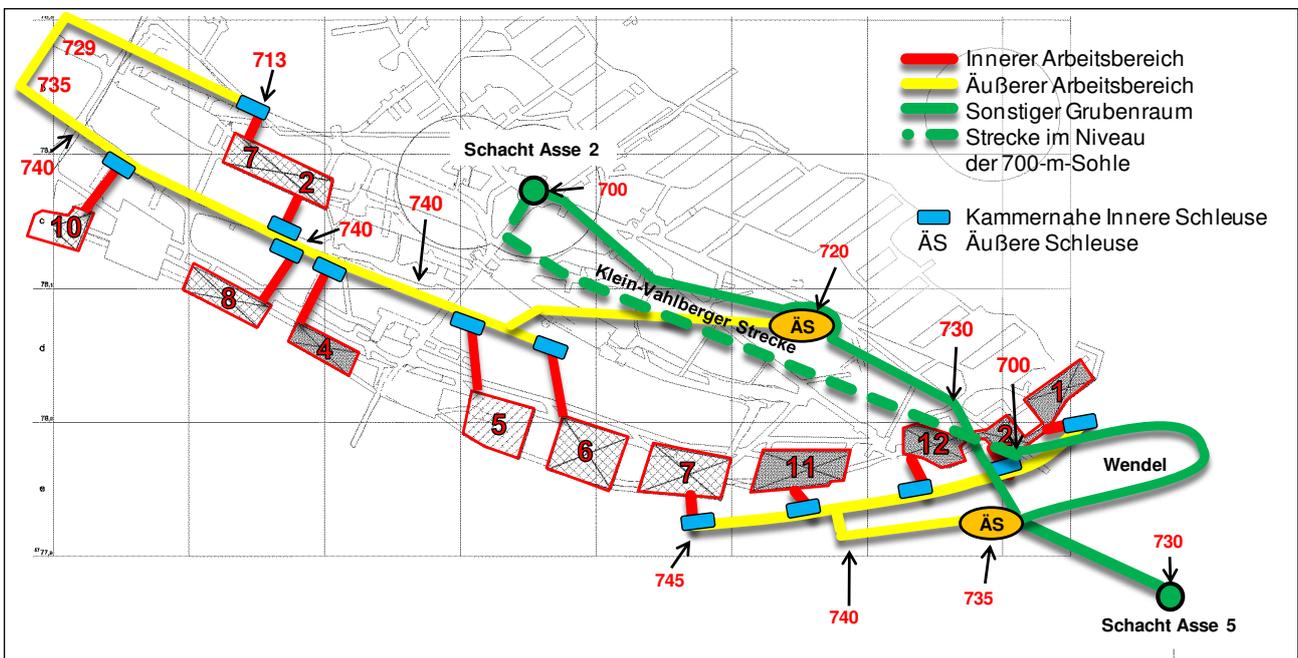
Schematische Darstellung der Mischvariante mit kammernahen Inneren Schleusen an beispielhaften Orten (Hintergrund: Grundriss der 750-m-Sohle)
